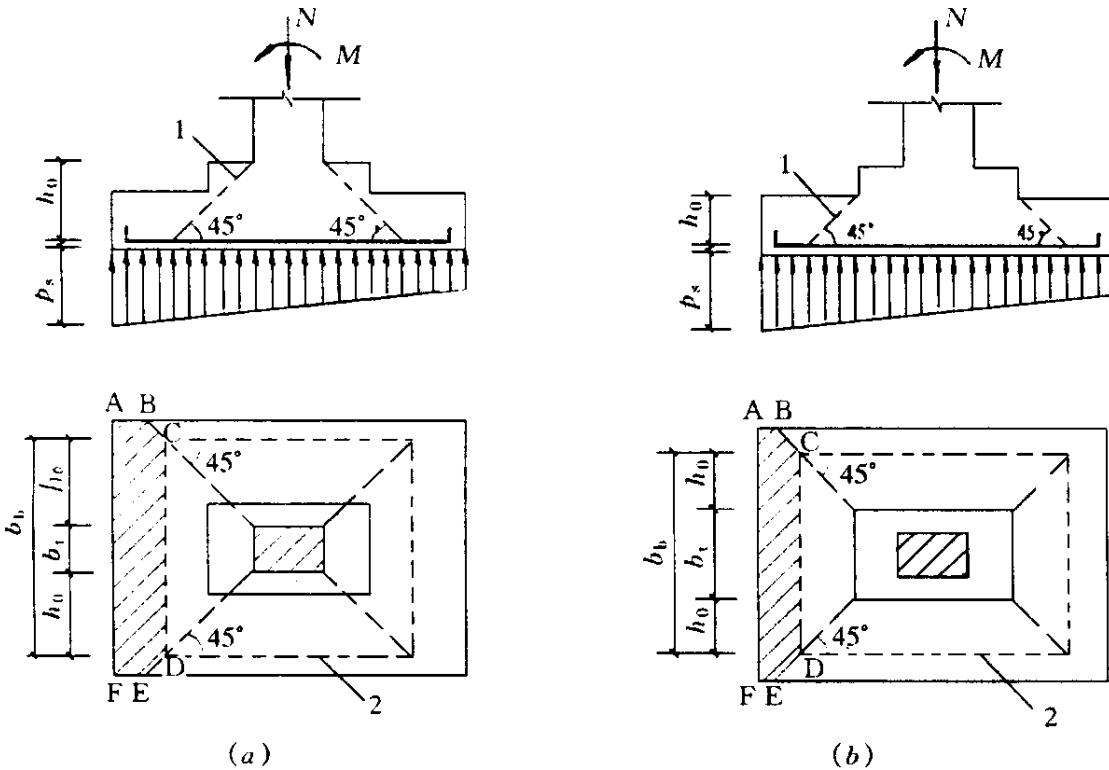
计算阶形基础的受冲切承载力截面位置
